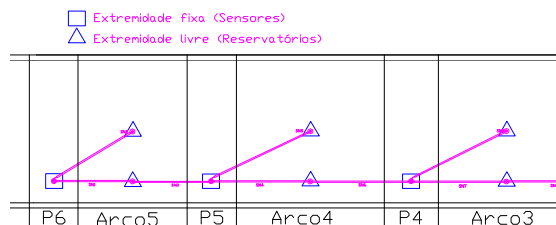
Posicionamento dos sensores de pressão (planta parcial de meia-ponte).
